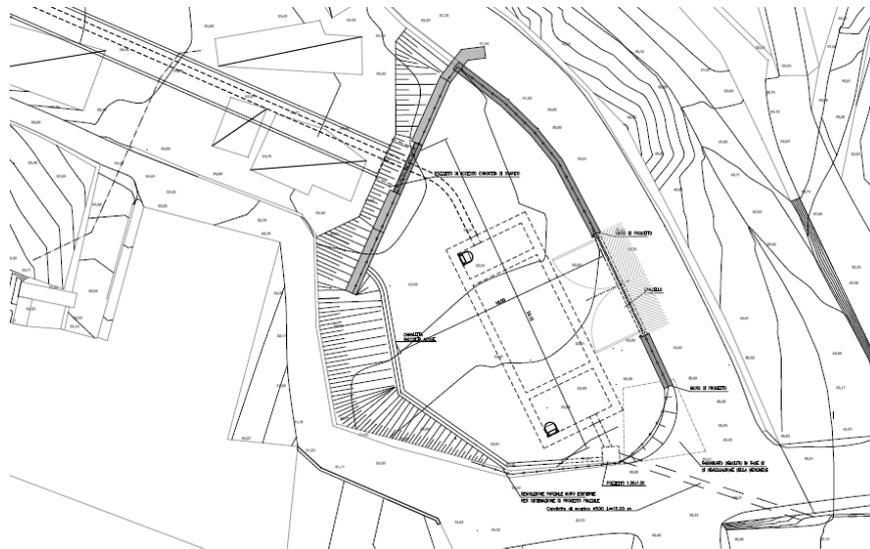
Planimetria di localizzazione della vasca di raccolta – WBS GN970
